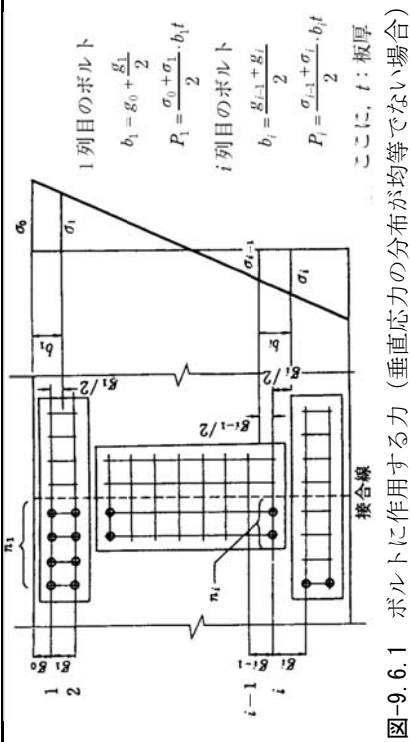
ボルトに作用する力 (垂直応力の分布が均等でない場合)
